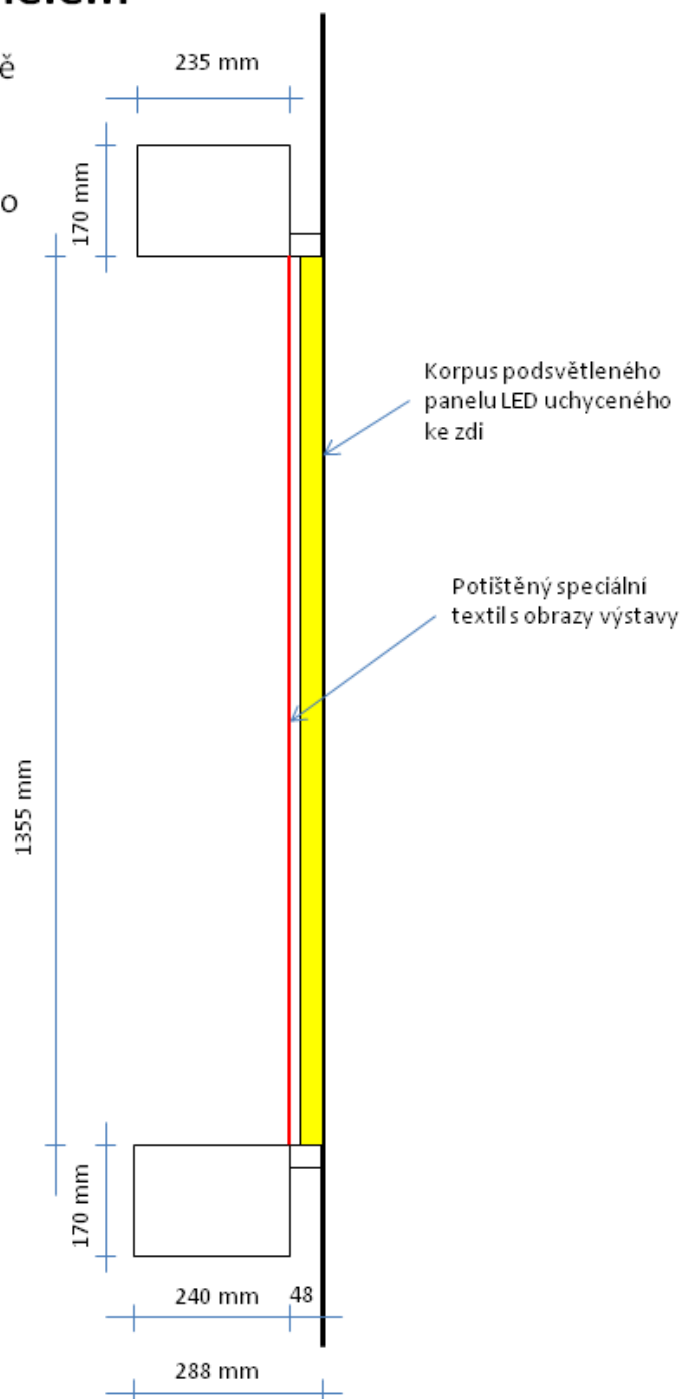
Řez bočním panelem pro umístění obrazové expozice.
